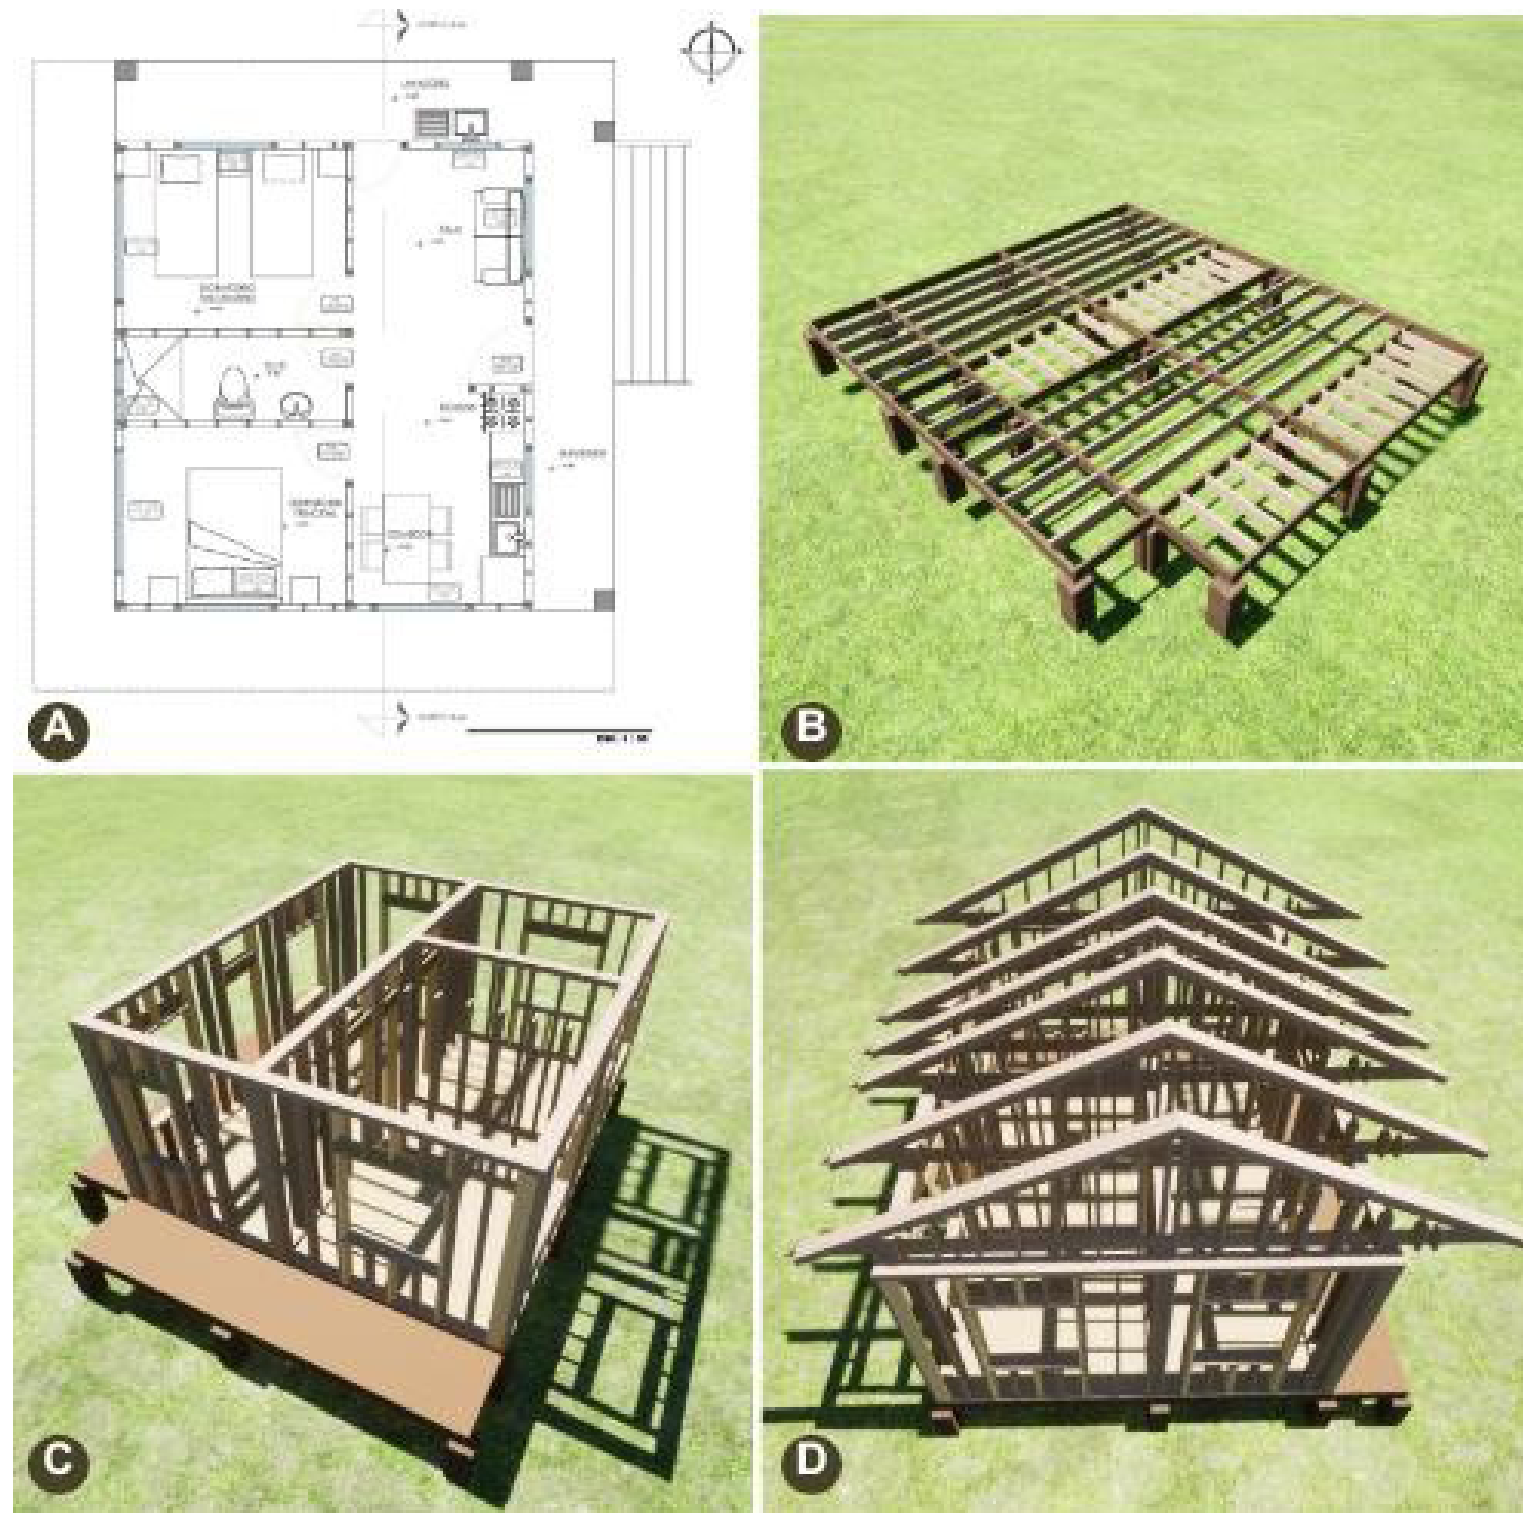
a) Planta de distribución (izquierda superior), b) Derecha superior: Estructuración de pilotes y entablado (derecha superior), c) Soporte de paneles, vigas y viguetas (izquierda inferior) y d). Distribución de la estructura del techo (derecha inferior).
